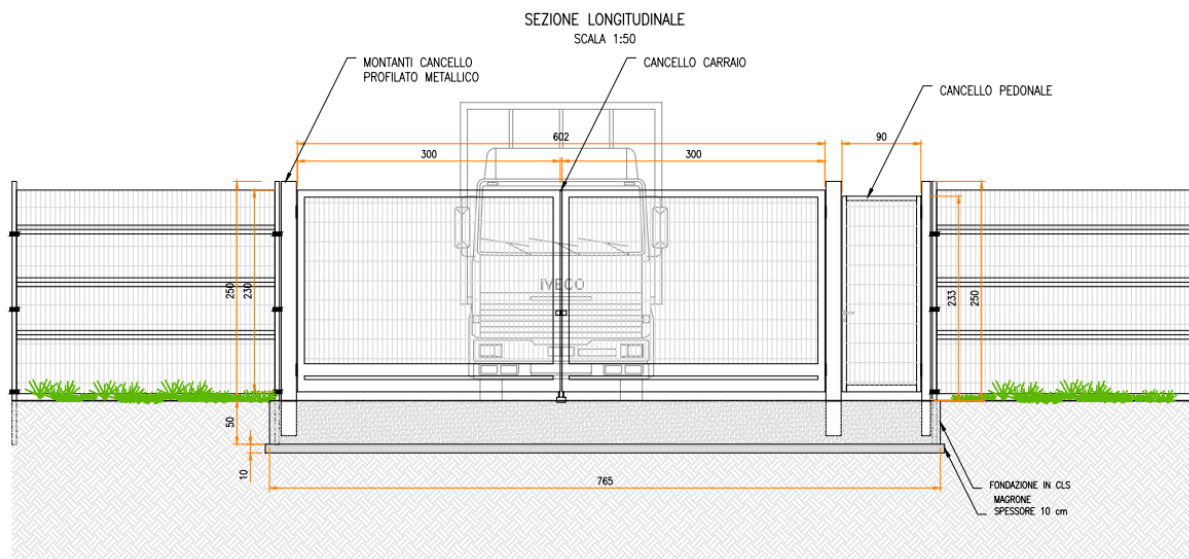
Sezione longitudinale accesso carraio e pedonale
